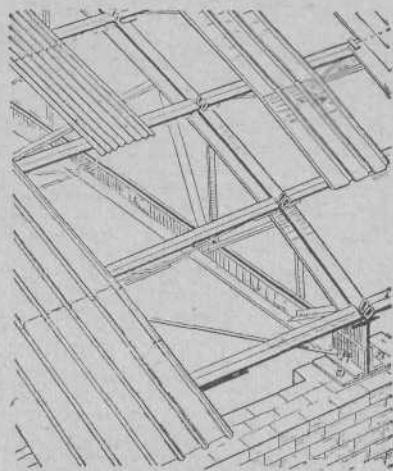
Стропильная ферма и кровля из гнутых профилей.
